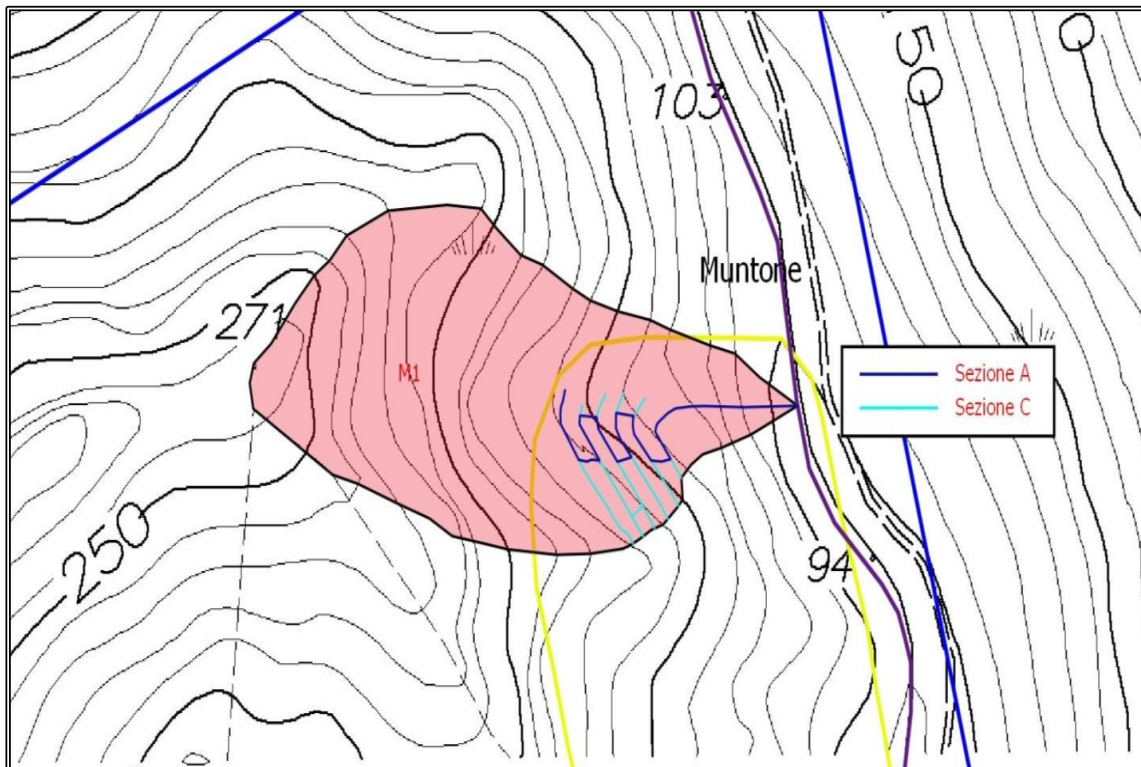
Schema della rete di drenaggio, con tipologia di sezione trasversale di progetto (Cantiere di Muntone M1).
